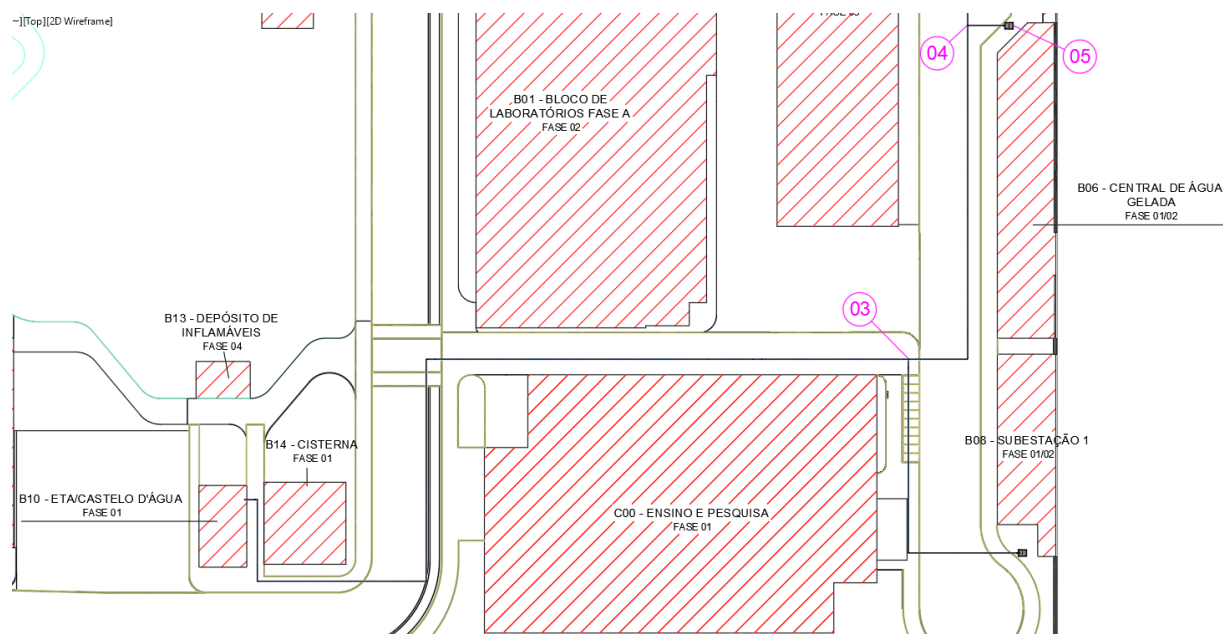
Planta trecho (Castelo d'água / Bloco B06)
